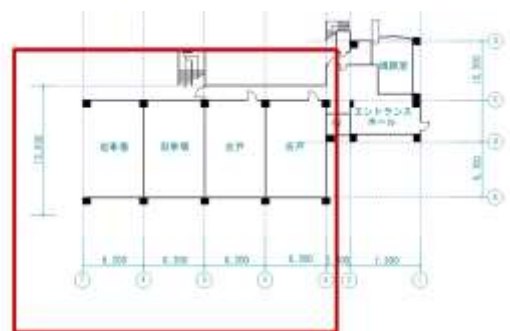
対象構造物②の 1 階平面図 (S=1/200)
